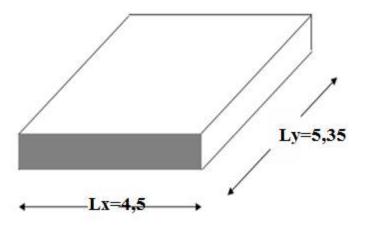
Vue en plan illustrant les dimensions du panneau le plus sollicité
